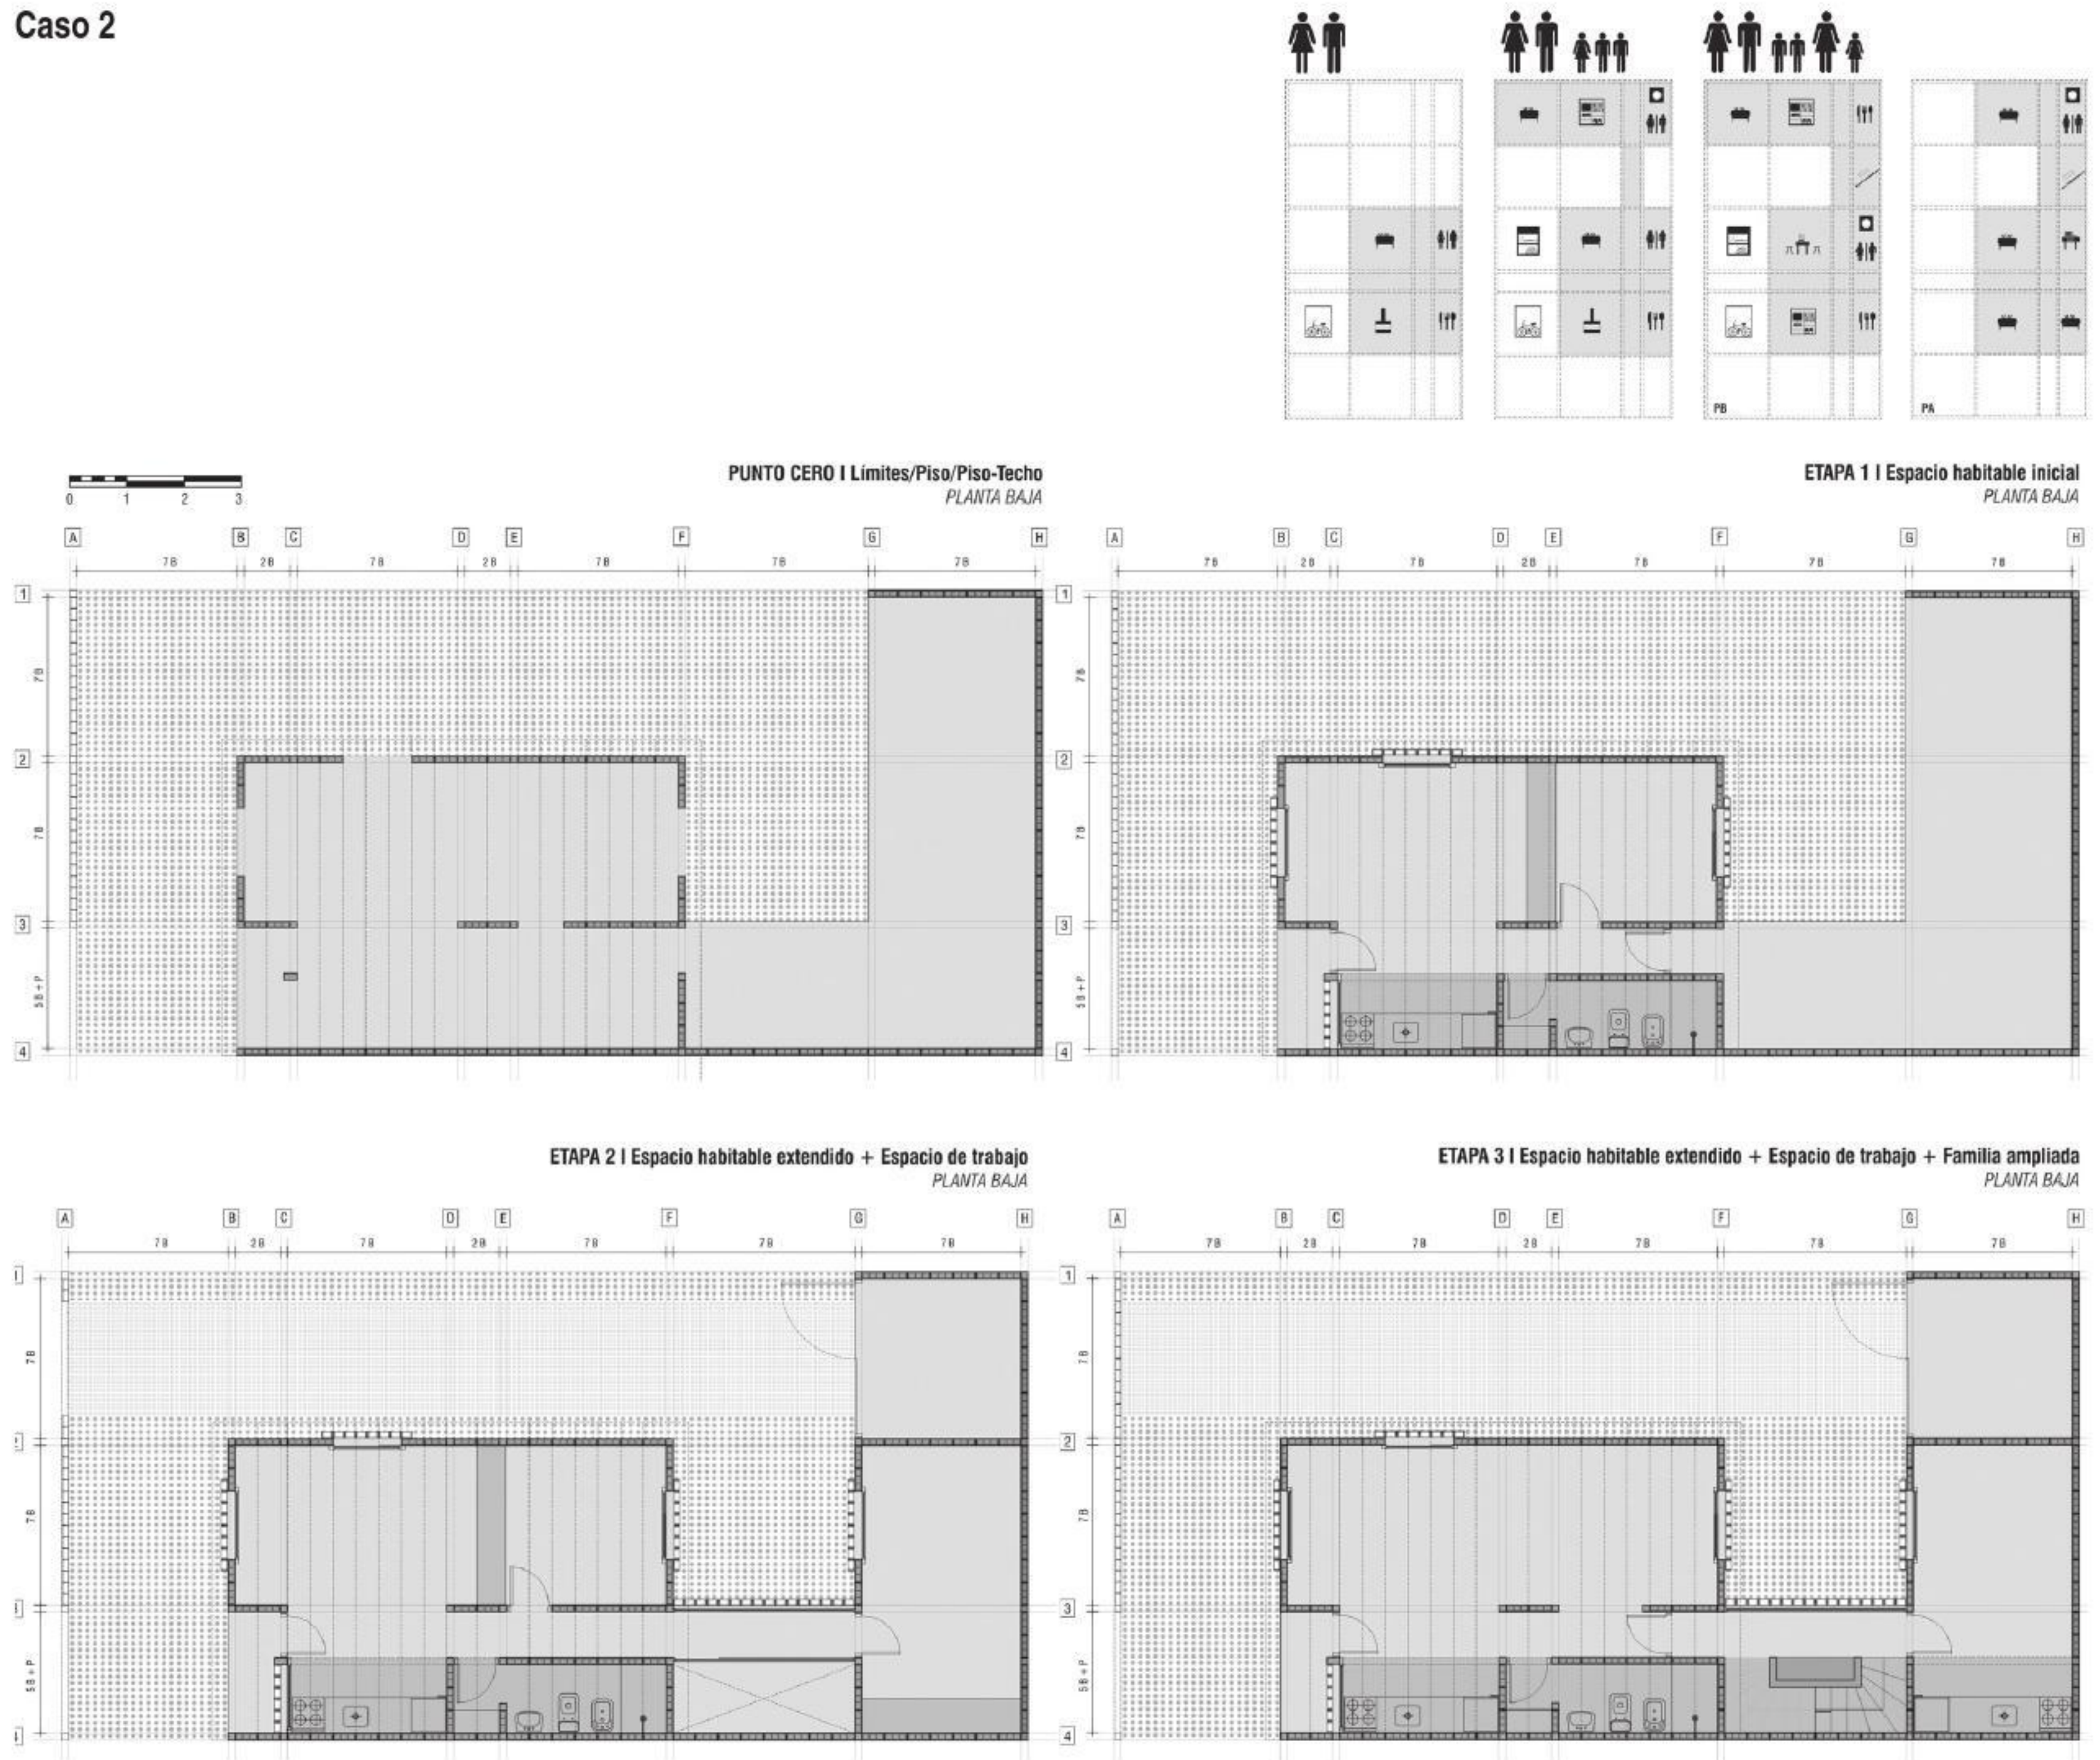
Caso 2. Plantas del desarrollo del plan de tránsito
